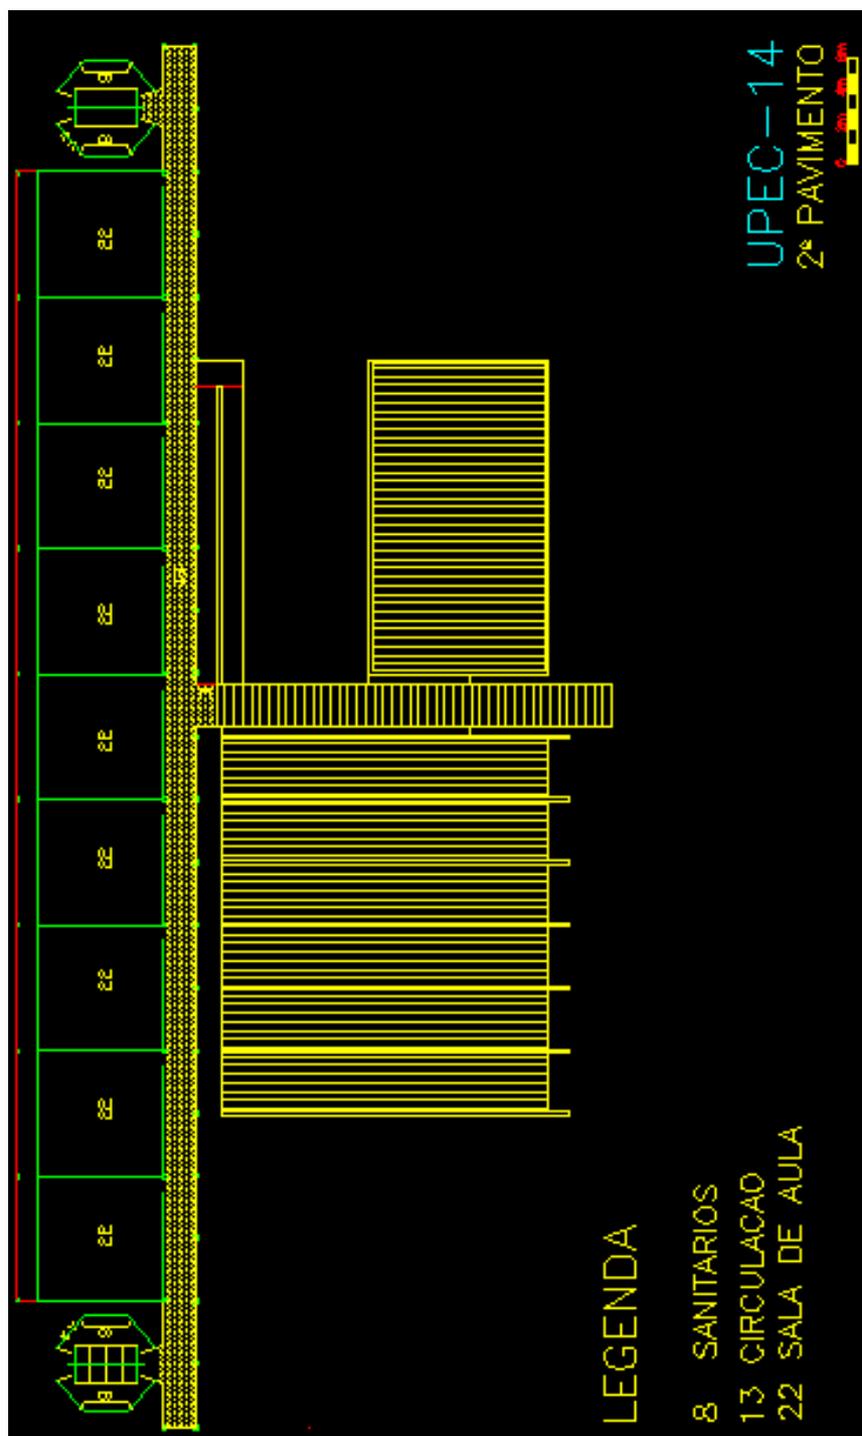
UPEC-14 / PLANTA 2º NÍVEL
